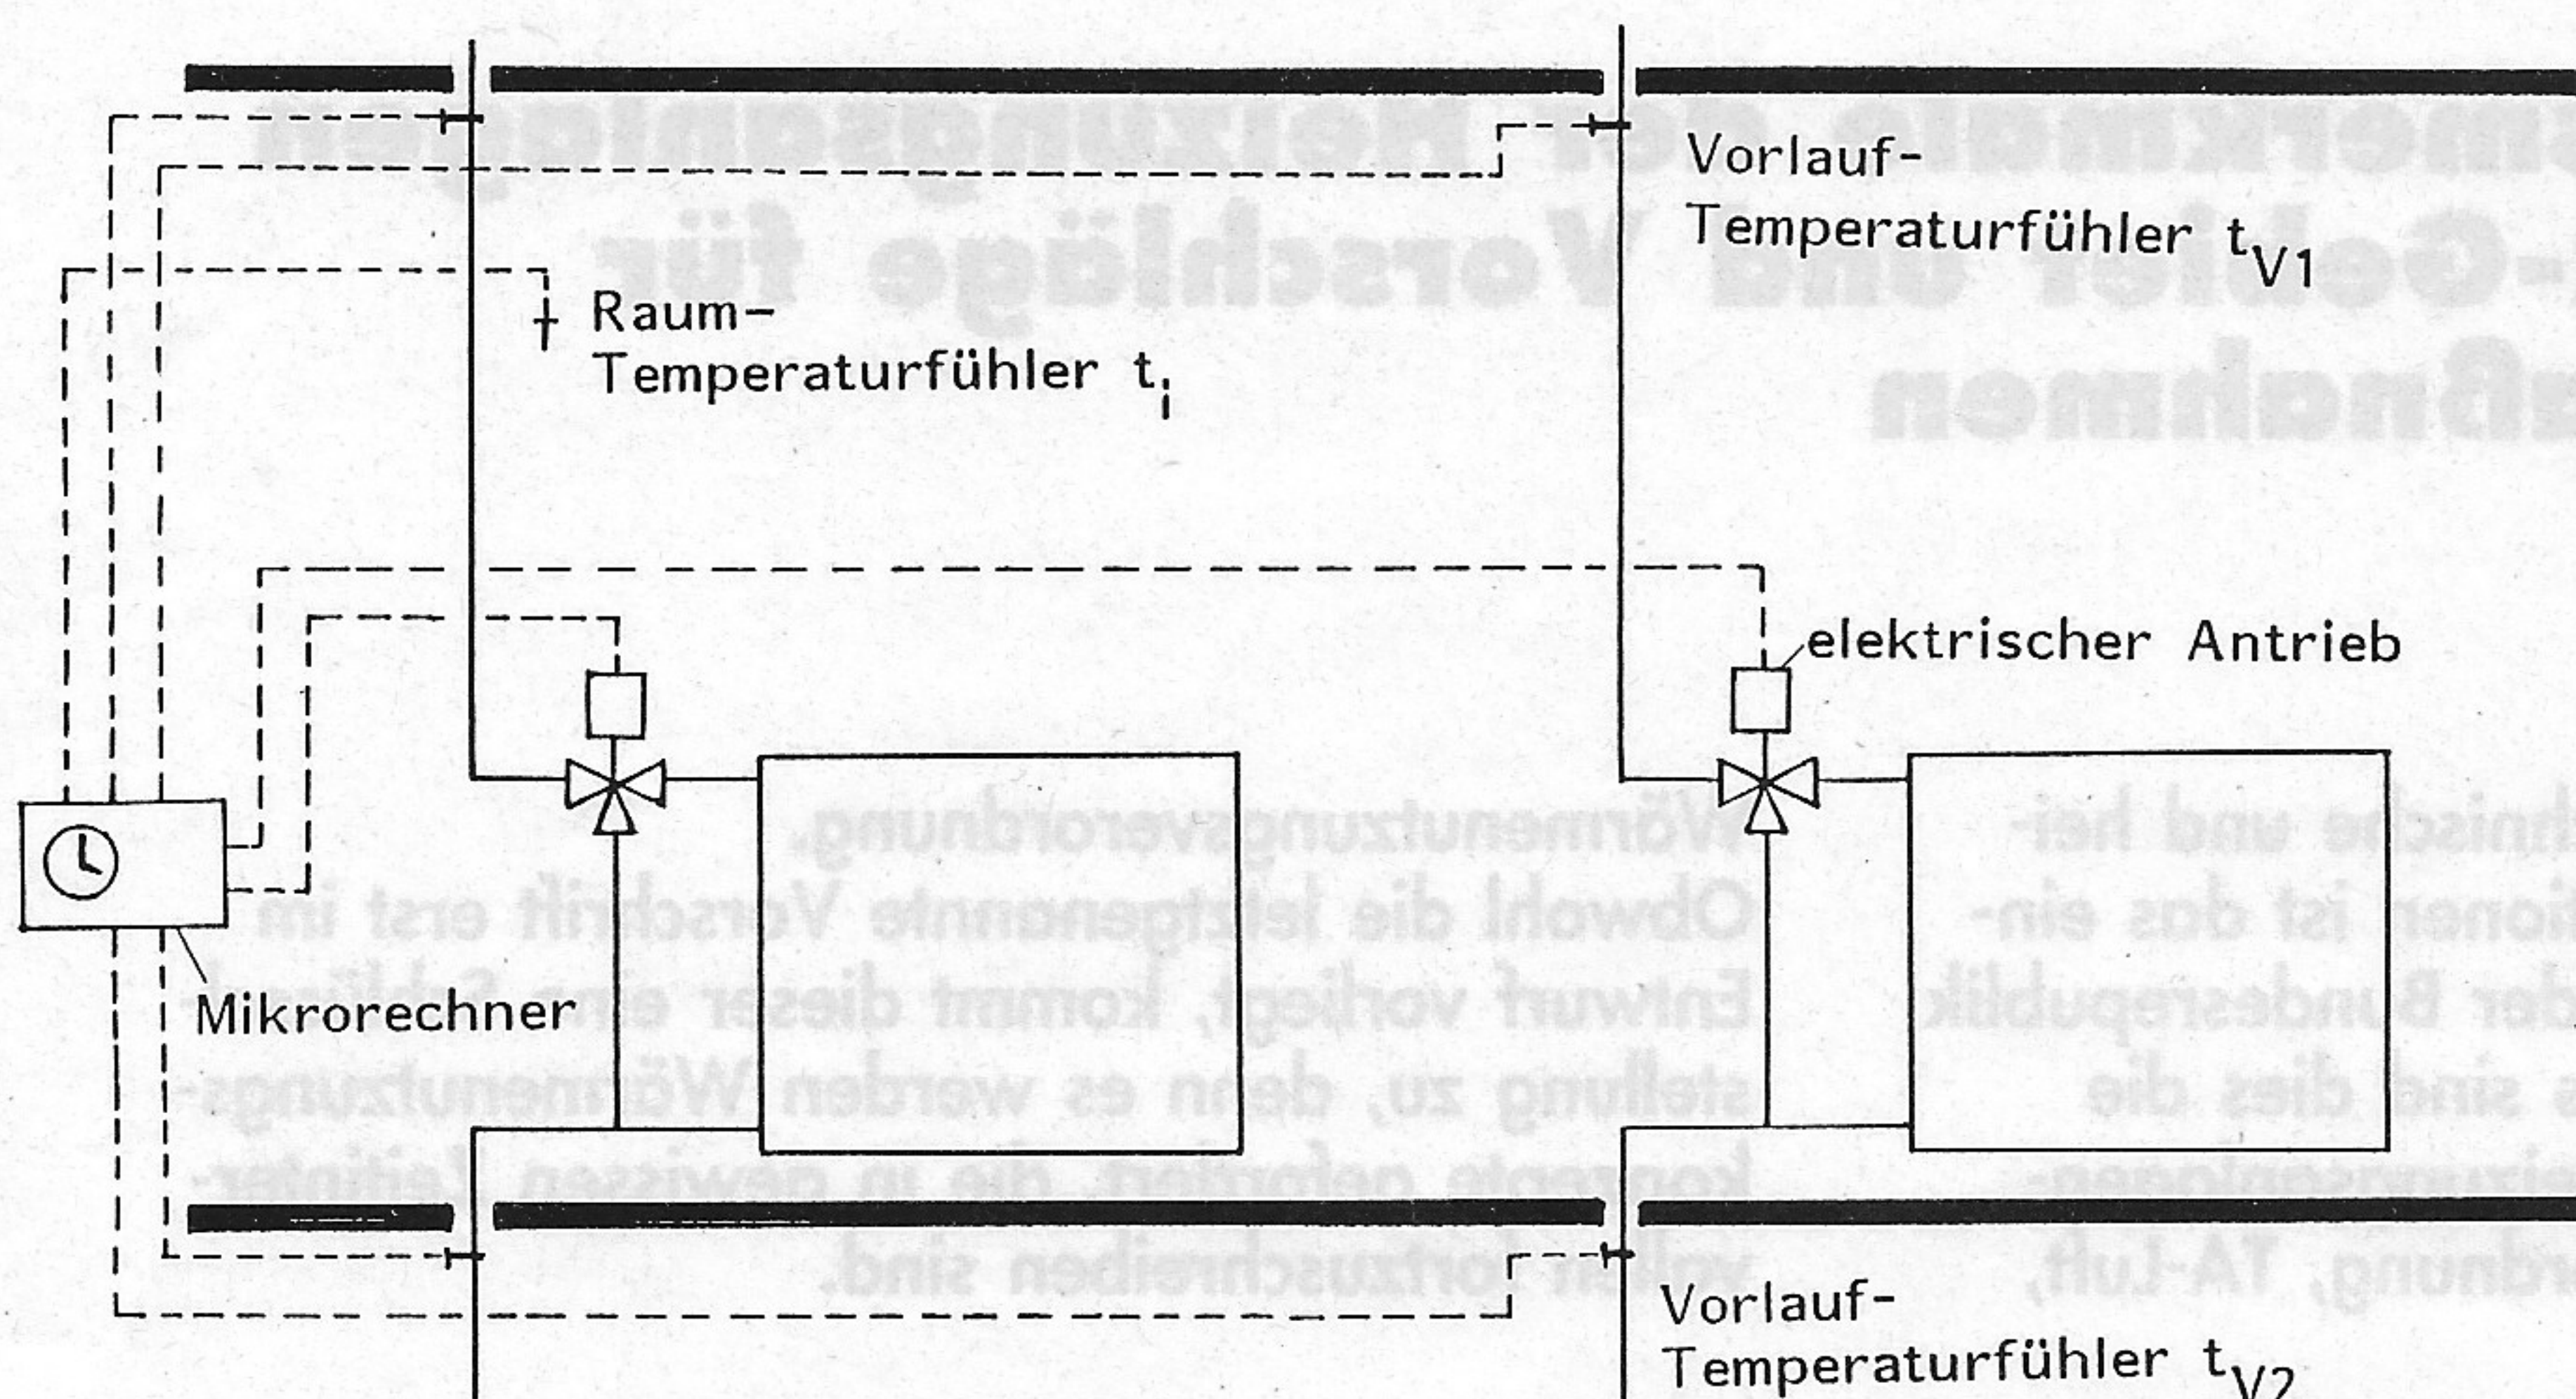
· Einbau eines Mikrorechners zur Steuerung der Raumnutzungszeit, der Temperaturregelung und der Wärmeverbrauchs-ermittlung als komfortable Sanierungsmaßnahme (Variante A) für bestehende senkrechte Einrohrheizungen mit Zweiwegventil und Kurzschlußstrecke
